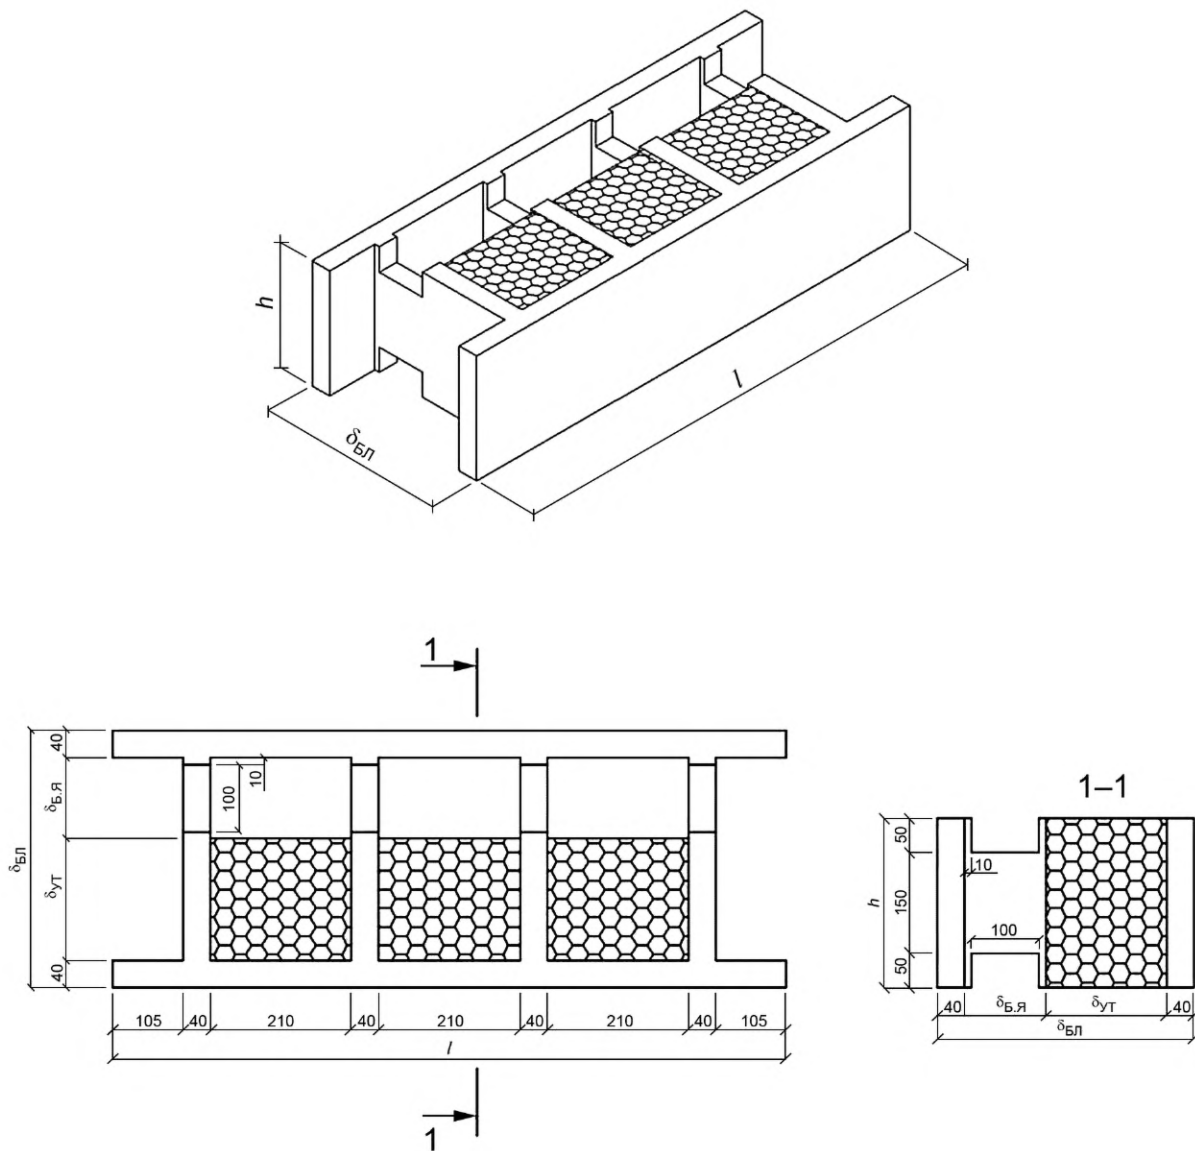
Блок наружной стены рядовой утепленный (НС-Р-УТ-38/15)
